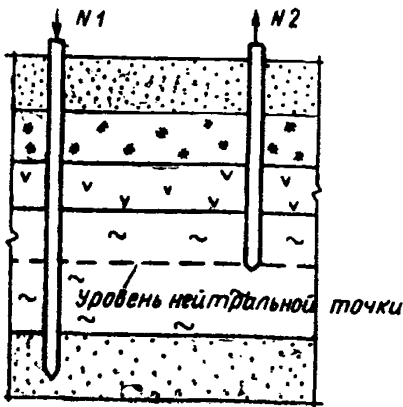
Схема испытаний свай с учетом отрицательного трения
